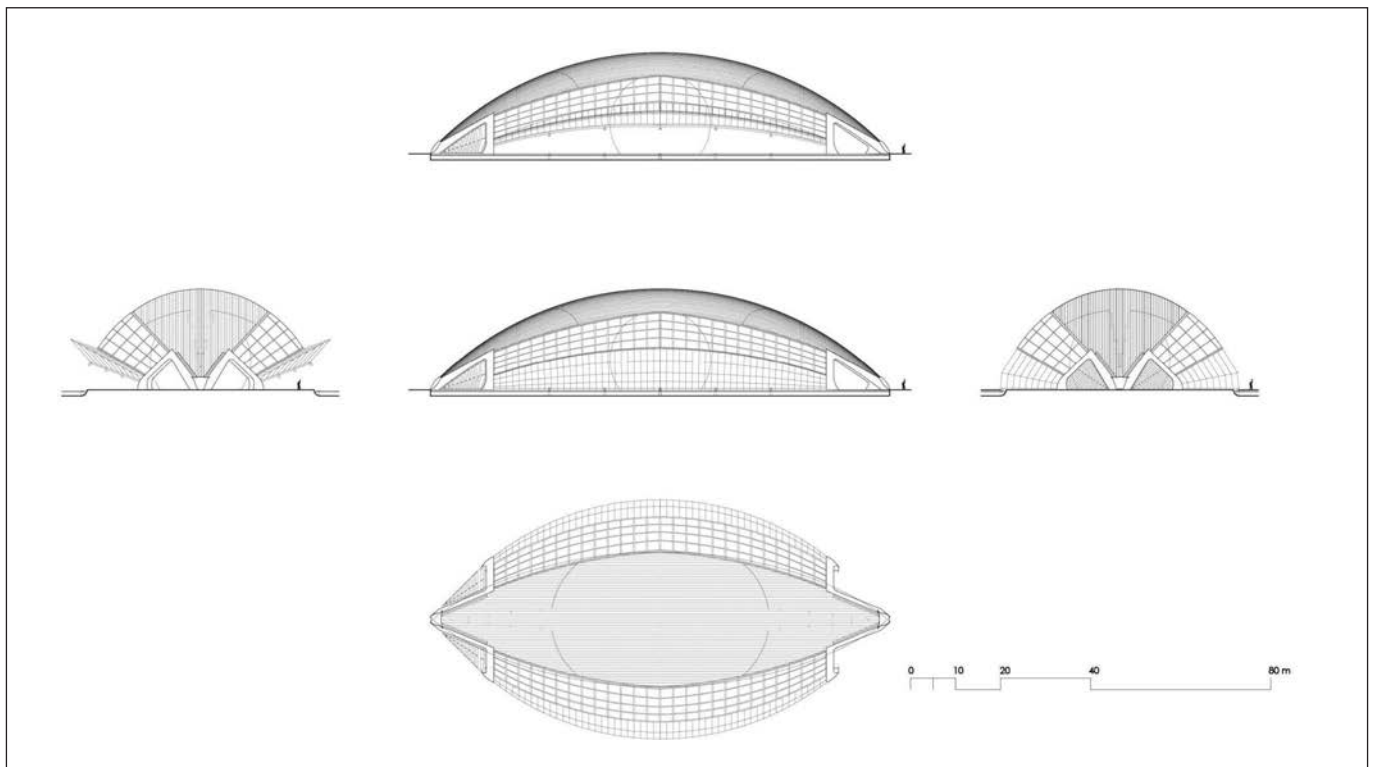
Planos de la cubierta de "l'Hemisfèric".
